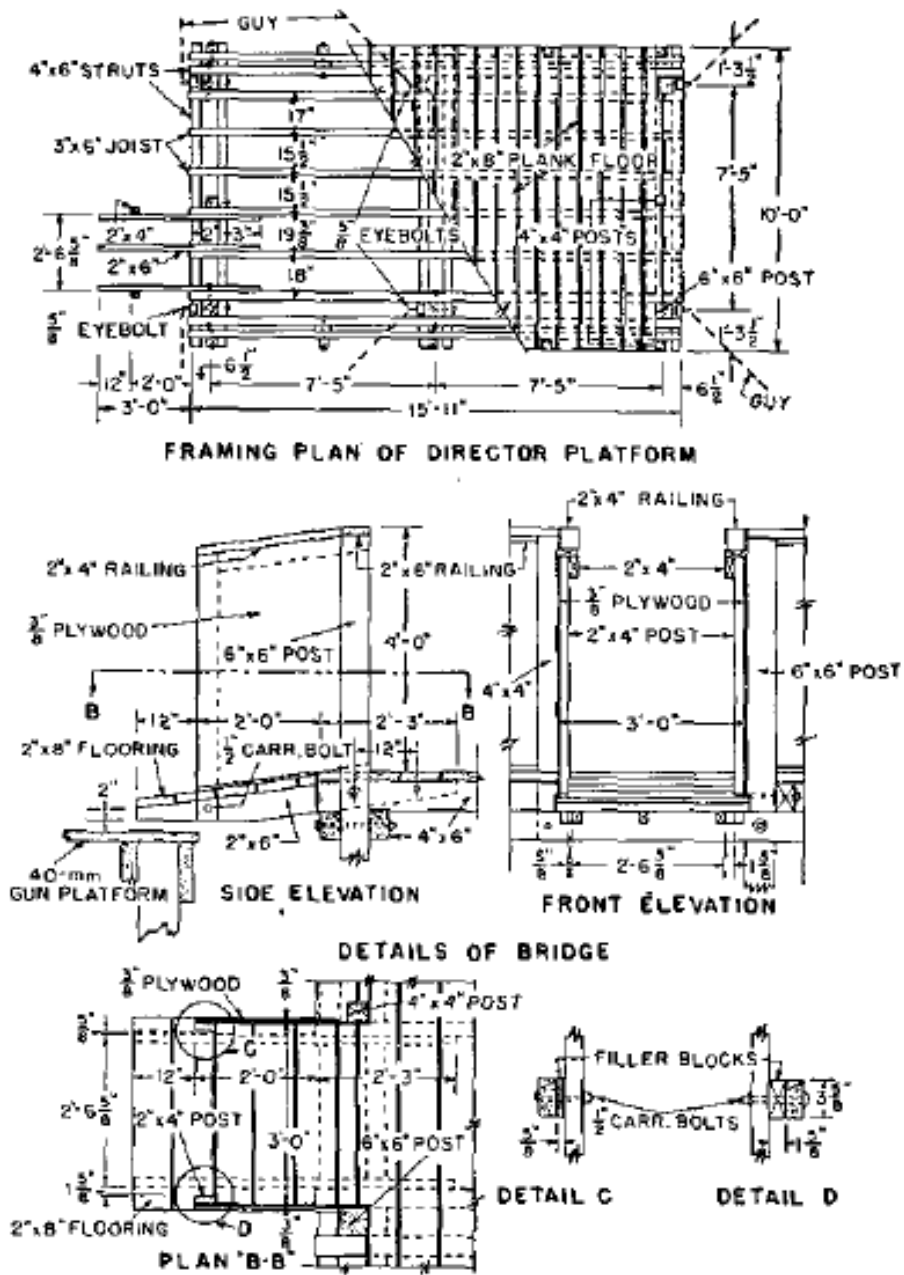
Protiletadlová věž – konstrukční detaily mezipater
